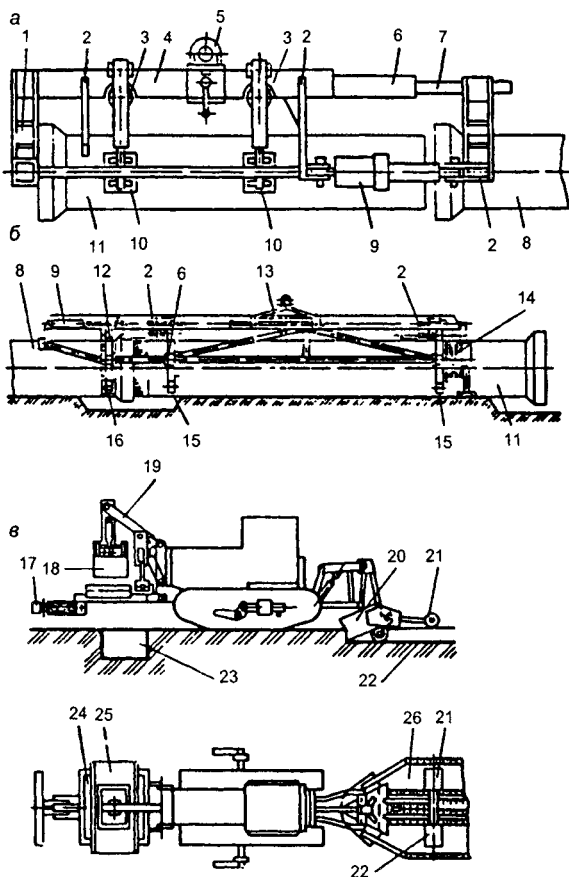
Схемы навесного устройства для монтажа железобетонных труб на резиновых уплотнительных кольцах (а), навесного оборудования для монтажа труб с раструбно-винтовым соединением (б) и траншейной машины для монтажа раструбных труб (в):
